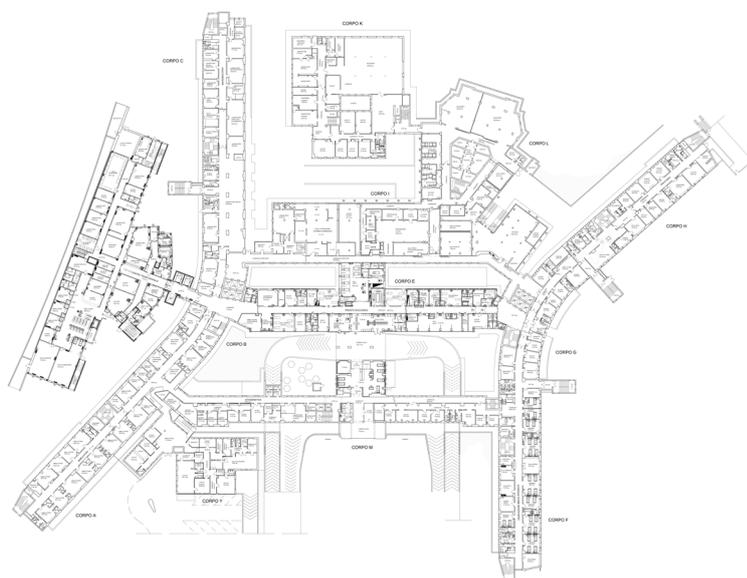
Pianta Piano Terra, Presidio Ospedaliero di Cremona, Edificio Monoblocco
